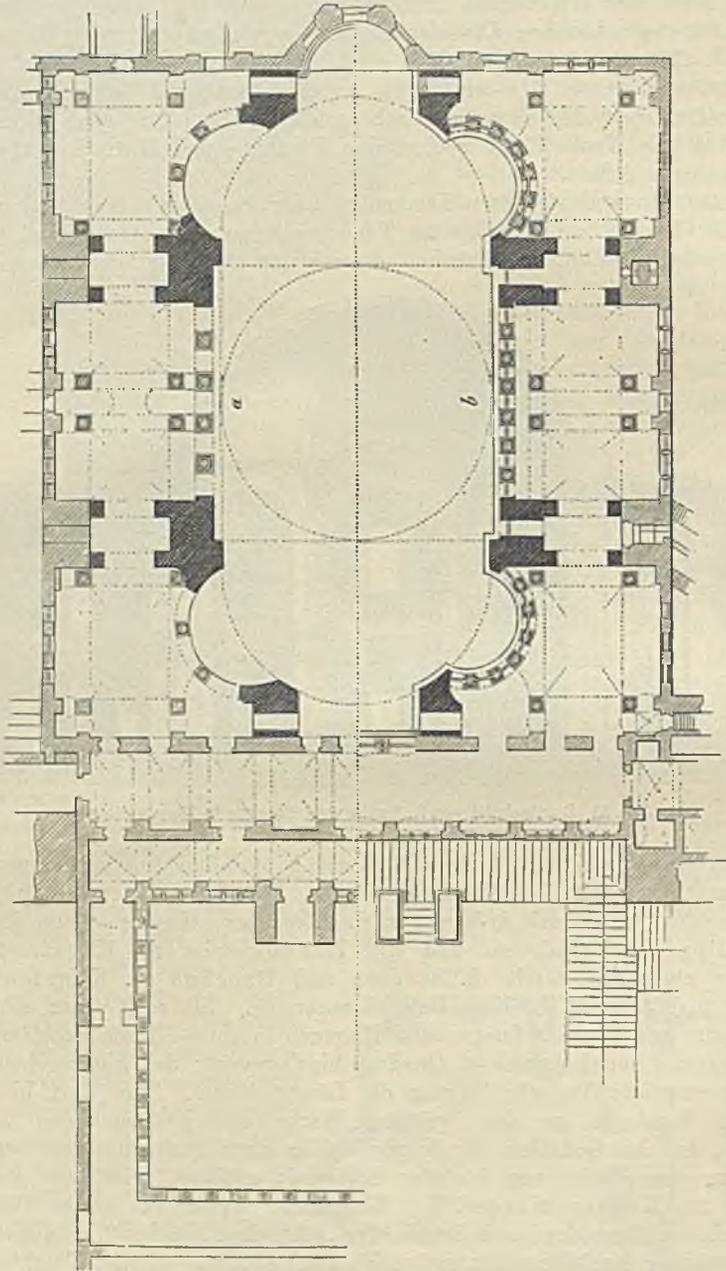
Grundriß (a Erdgeschoß, b Emporen) der Sophienkirche in Konstantinopel
